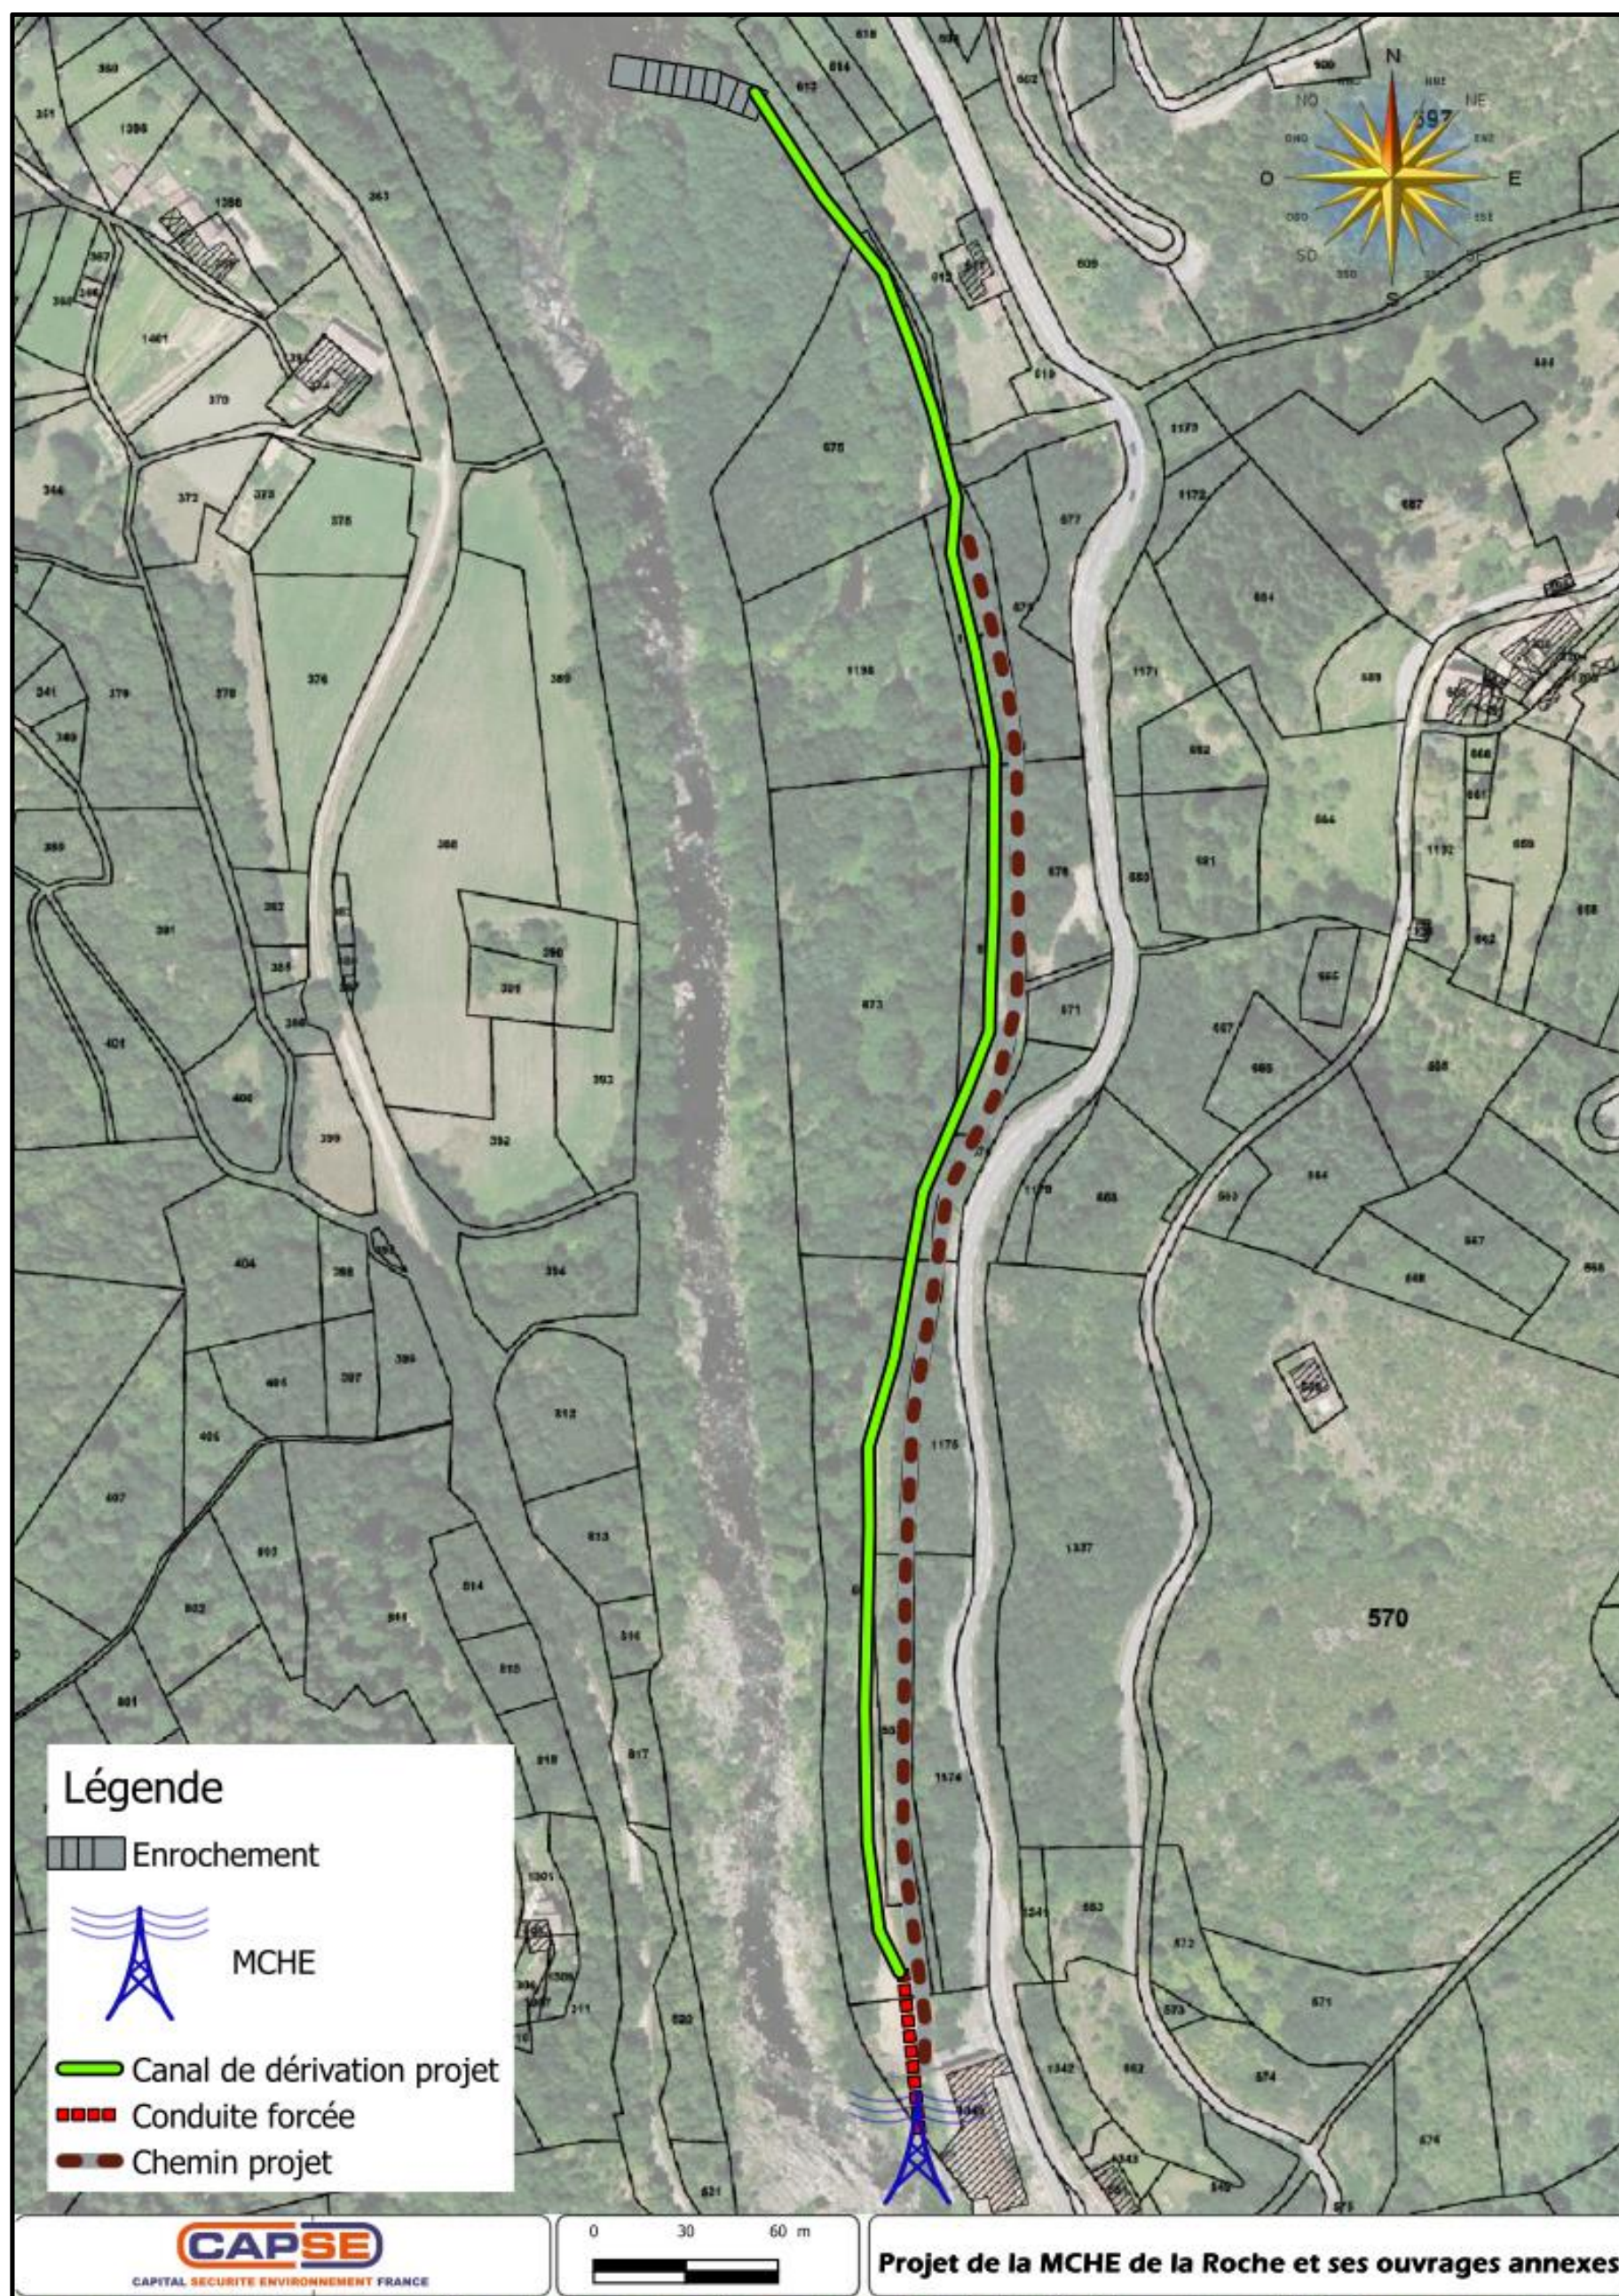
Plan cadastral du nouveau projet de la MCHÉ de la Roche
